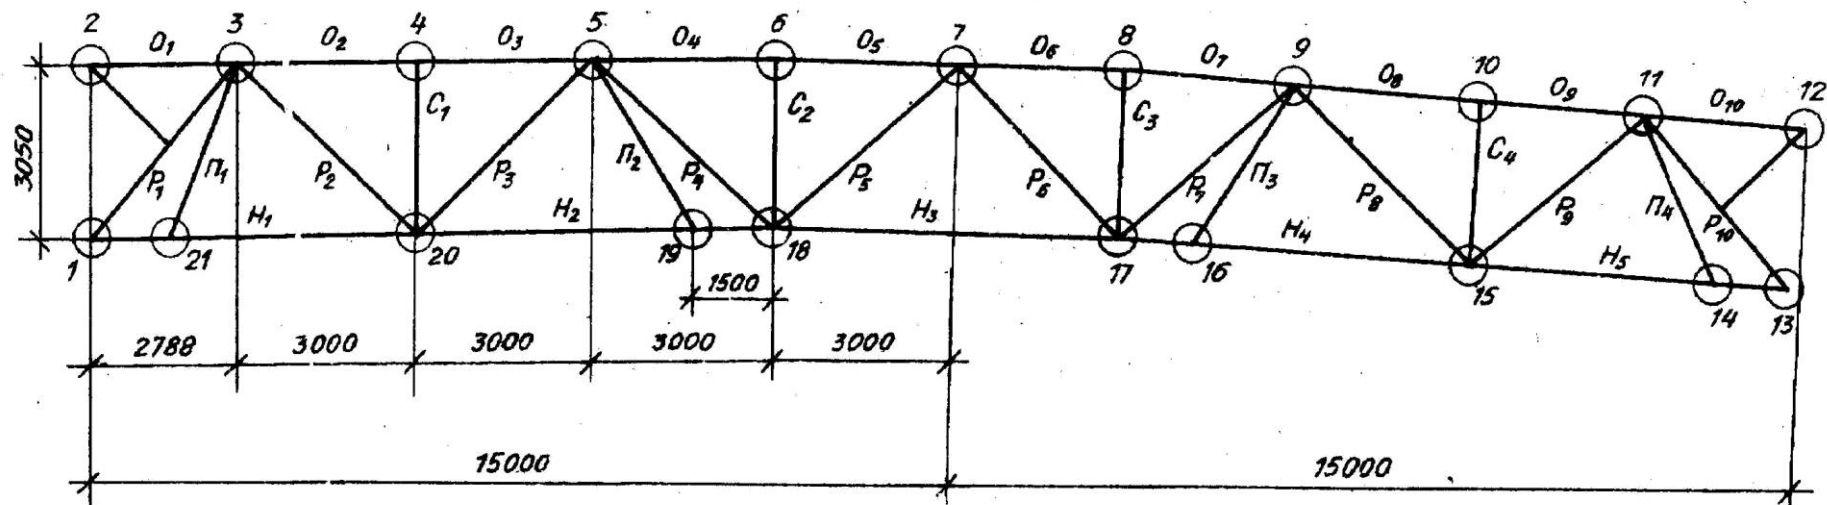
Геометрическая схема фермы VIII ФС-30 – 2, 50
